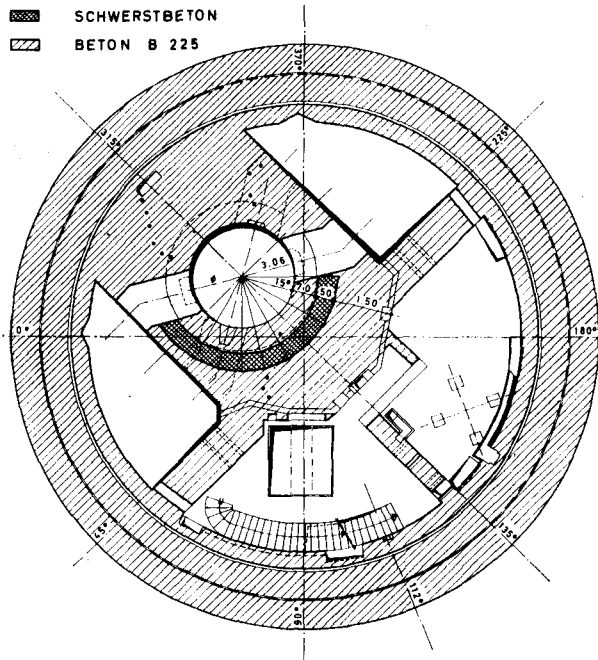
Horizontalschnitt durch das Reaktorgebäude mit der Schwerstbetoneinlage.
